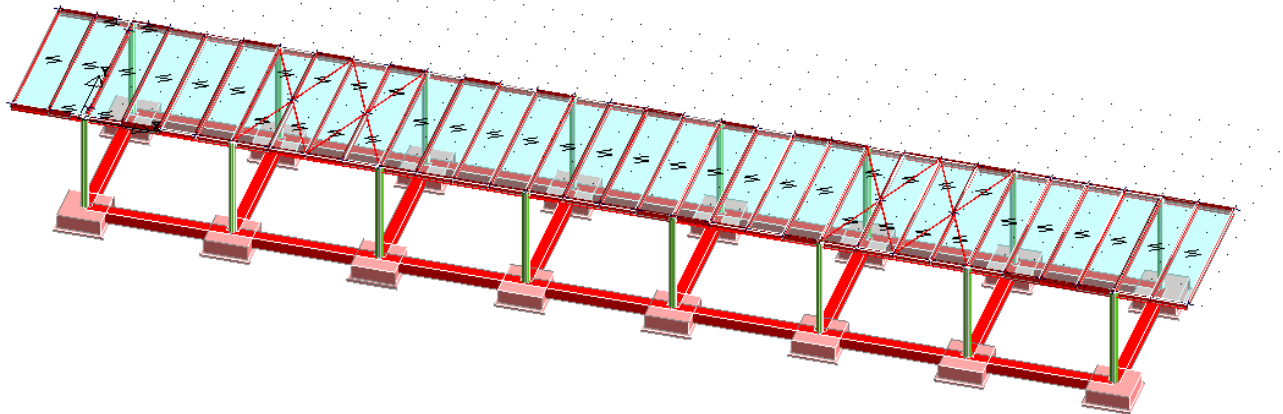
Modulo Standard – Vista 3D – struttura di copertura
